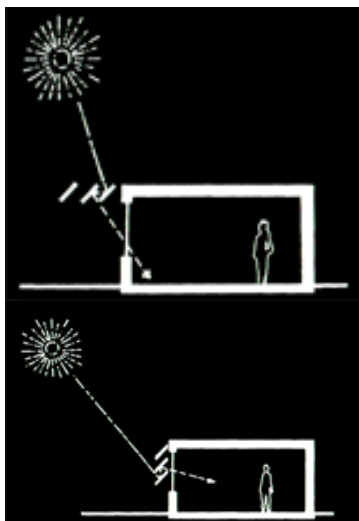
Para fachadas Sul, brise de lâminas protege mais e permite a luz difusa.
